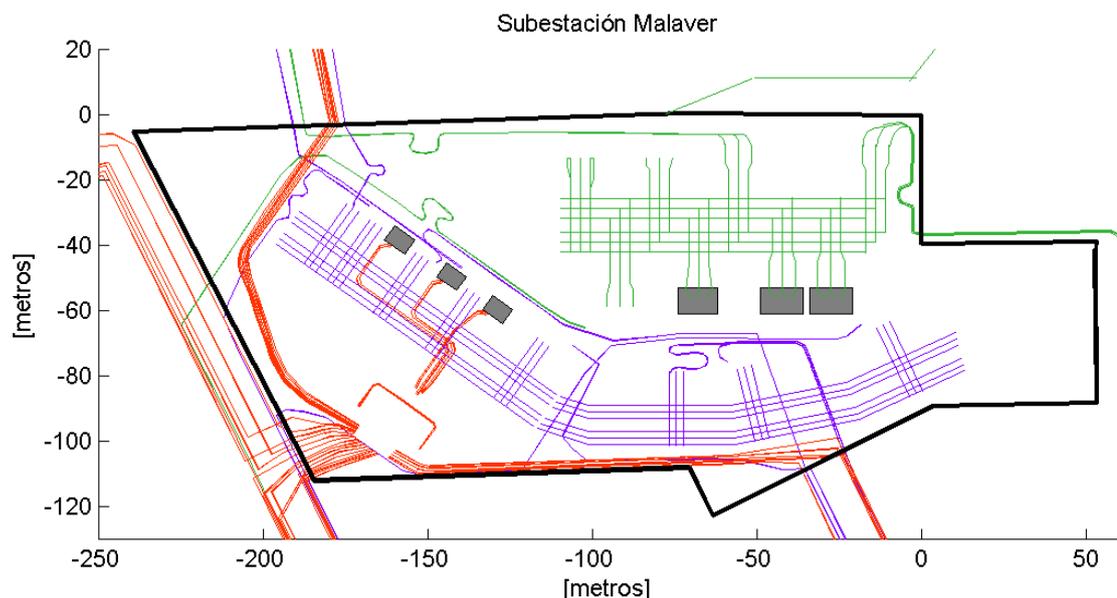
Vista en Planta de la Subestación Malaver. (Situación Futura)
